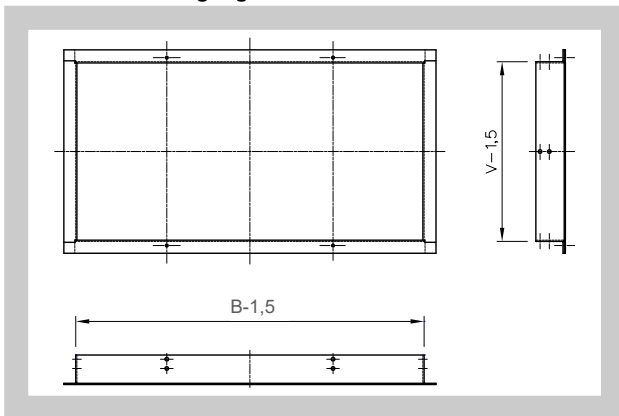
Befestigungsrahmen mit Halterung für Gipsplatte
